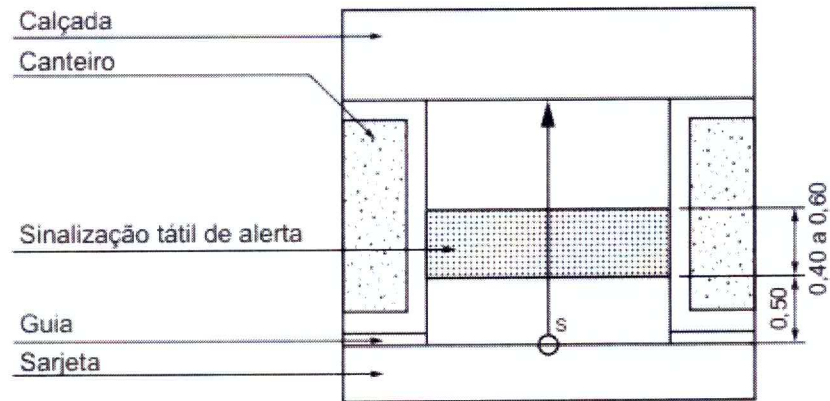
Rebaixamento de calçada com faixa de serviço/canteiro.
